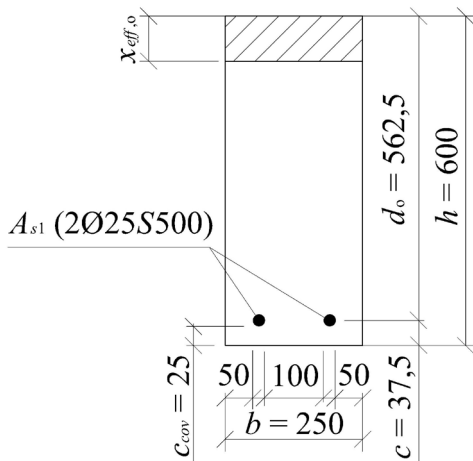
Расчетное сечение балки с оставшейся арматурой
